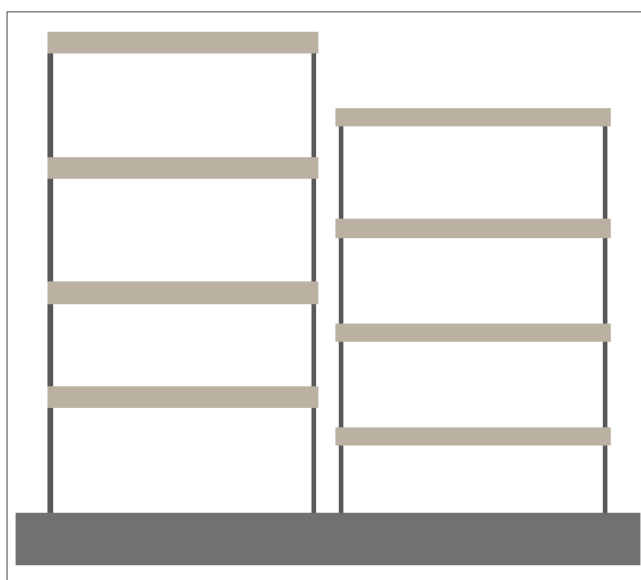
Constructions avec hauteur et nombre de niveaux différents (Vue élévation)
